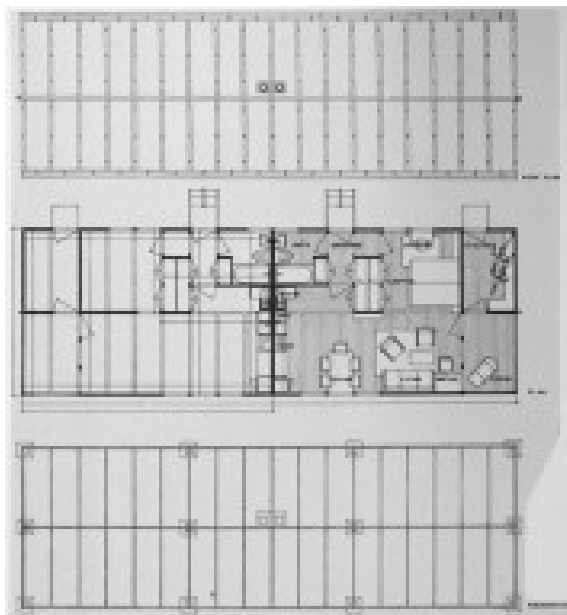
Planos do projeto "Pavillon Dismontable". JEAN PROUVÉ, 1945. ([Adaptado a partir de:] Sap, 2018)
